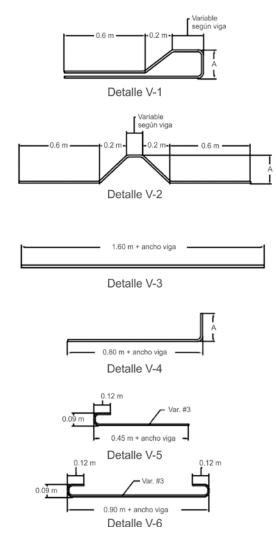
Detalles constructivos de Losa Lex (continuación)
